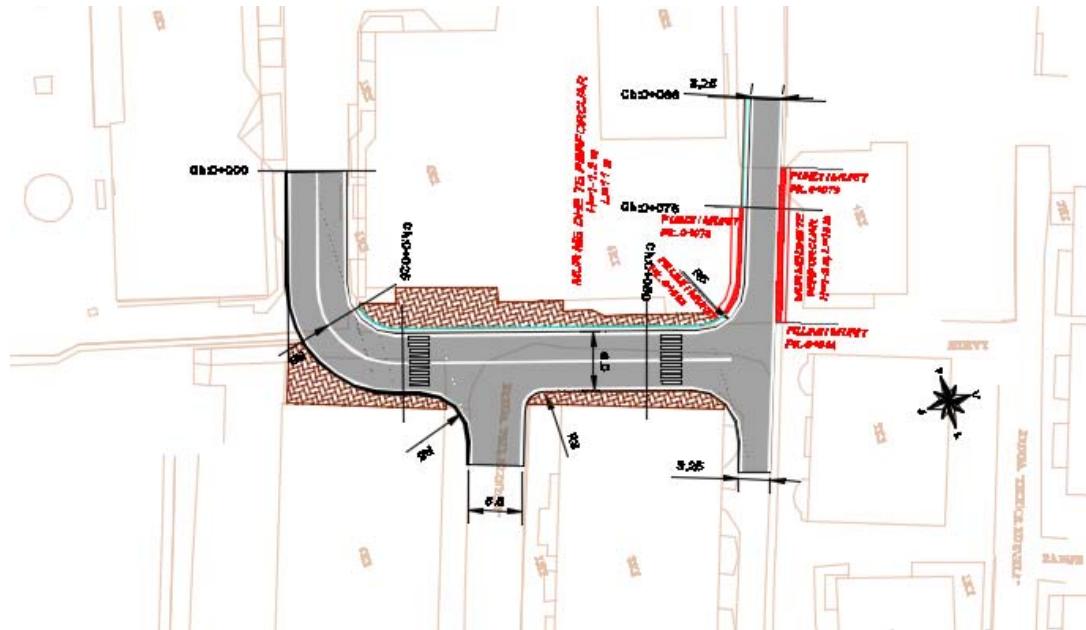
Planimetria e lidhjes se Rruges Nr.7 me Rrugen Nr.8
